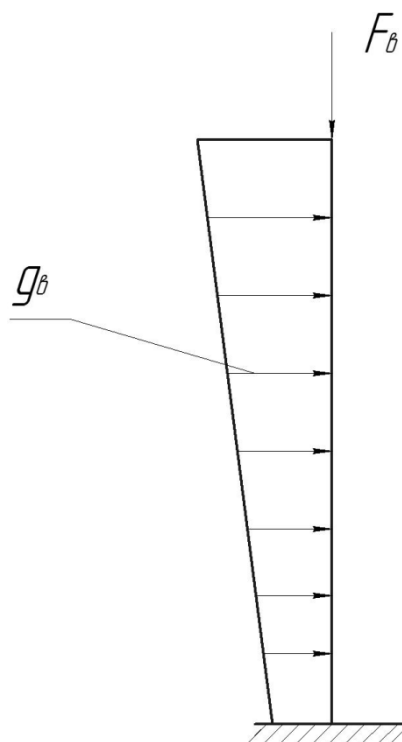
Расчетная схема при наличии ветровой нагрузки q_b
